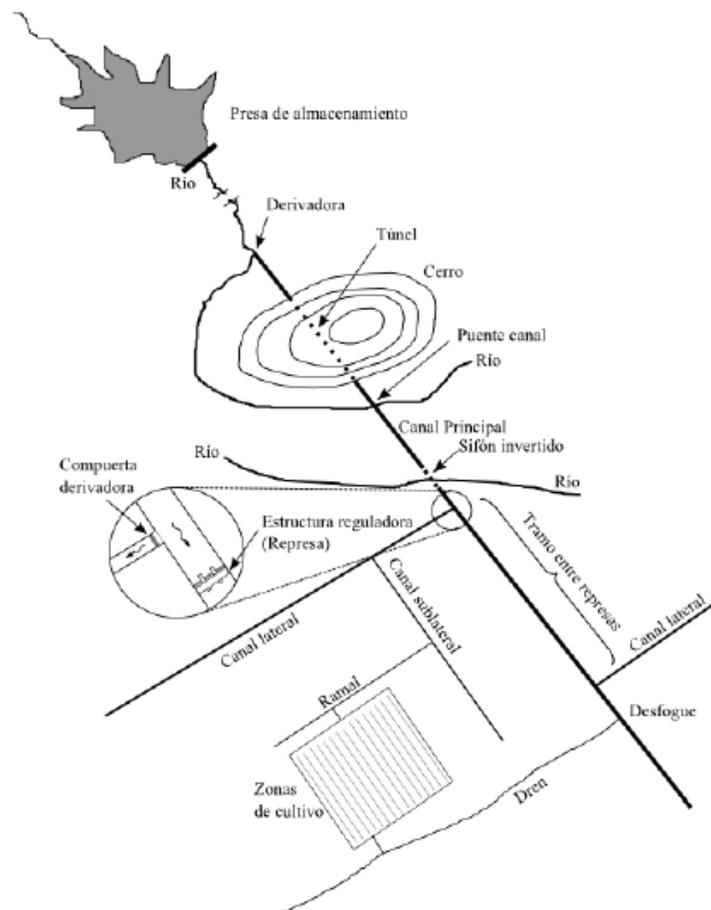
Esquema simplificado de la infraestructura en un distrito de riego.
